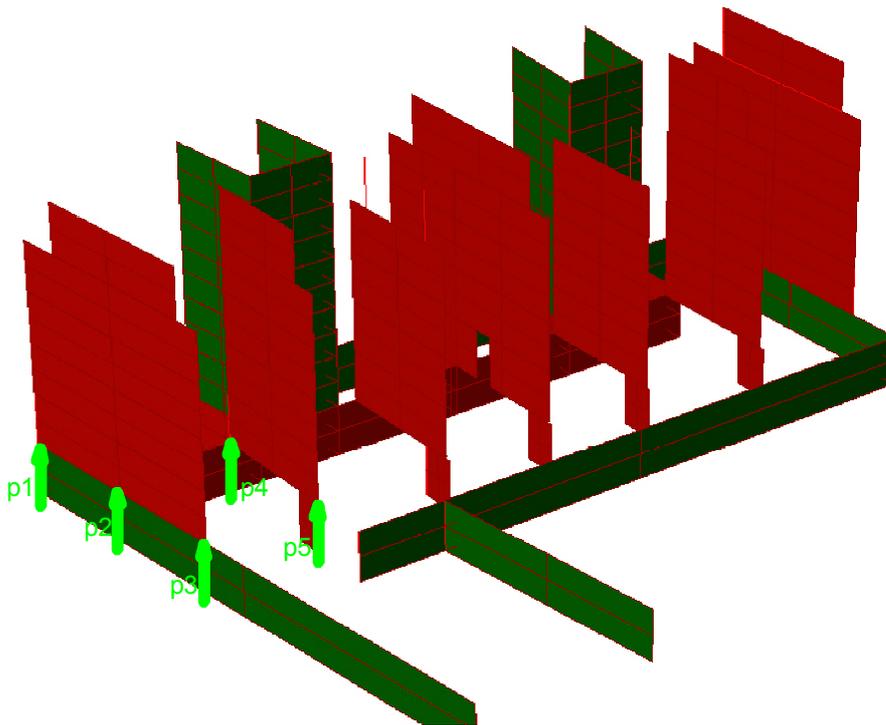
Auflagerpunkte der Wandscheiben im Kellergeschoss
